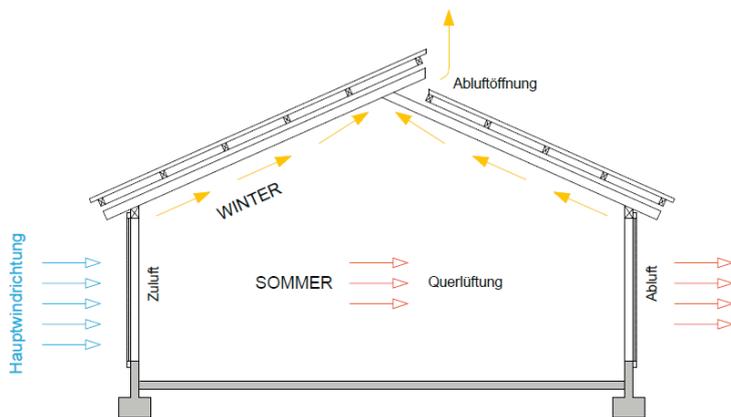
| Systemdarstellung Halle mit Querlüftung, © ÖKL
